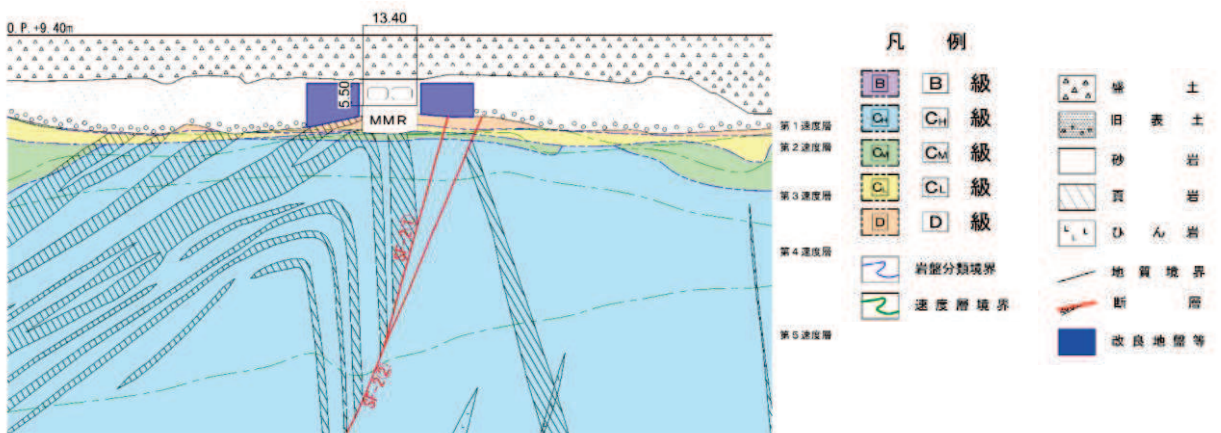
地盤改良体の配置図 (取水路, B-B 断面)
